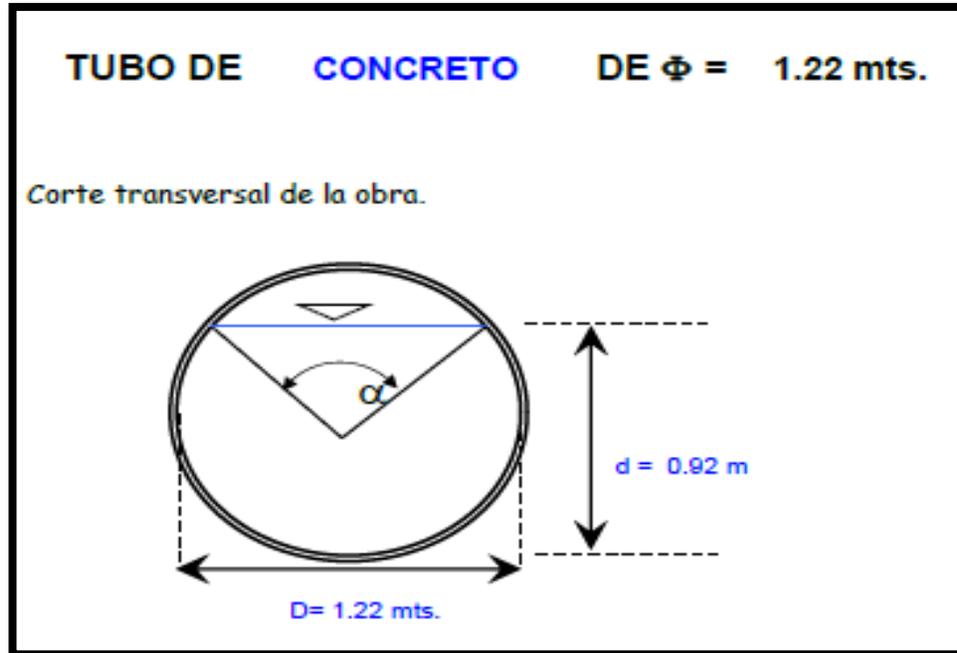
Alcantarilla de tubo de concreto de 1.22 x 1m.
